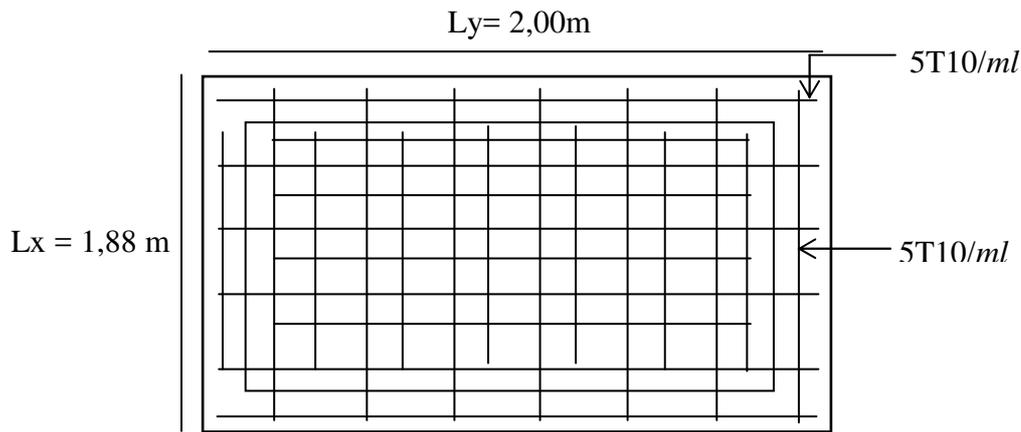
Dessin Ferrailage Supérieur du panneau de la dalle pleine.
